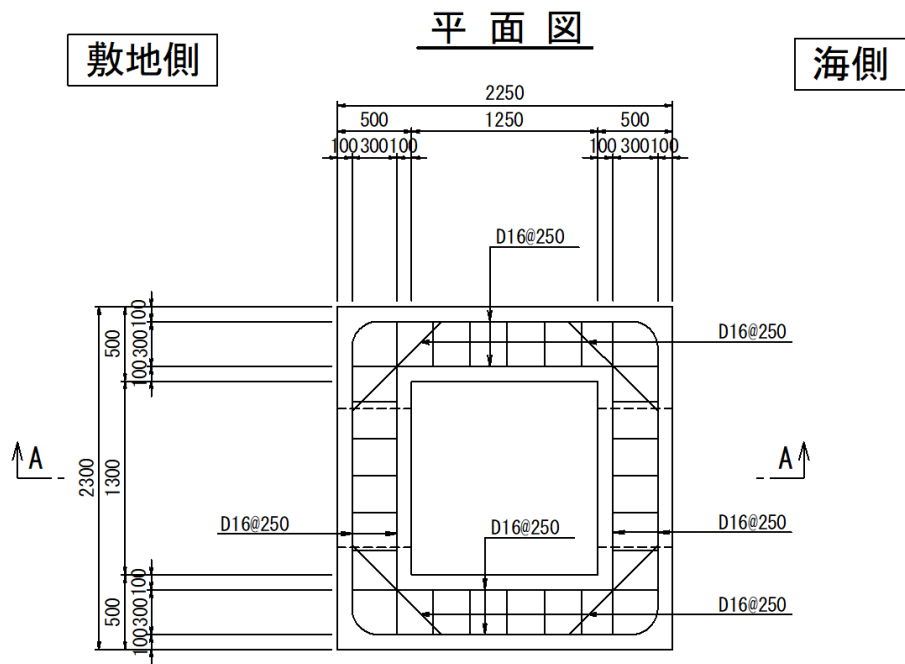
(6) 概略配筋図 (集水桝 (屋外排水路逆止弁⑨))
